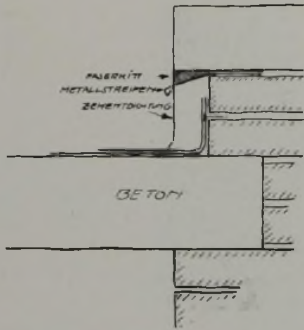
Doppelte Papplage auf Betondach mit Mauerbrüstungsanschluß durch übersetzte Rollschicht, Zementmörtel oder hydraulische Kalkmörteldichtung, Metallstreifensicherung und Verstrich mit Faserkitt. Der Metallstreifen kann u. U. fortgelassen werden, dafür ist die Rollschicht mit Neigung weiter vorzustrecken.
